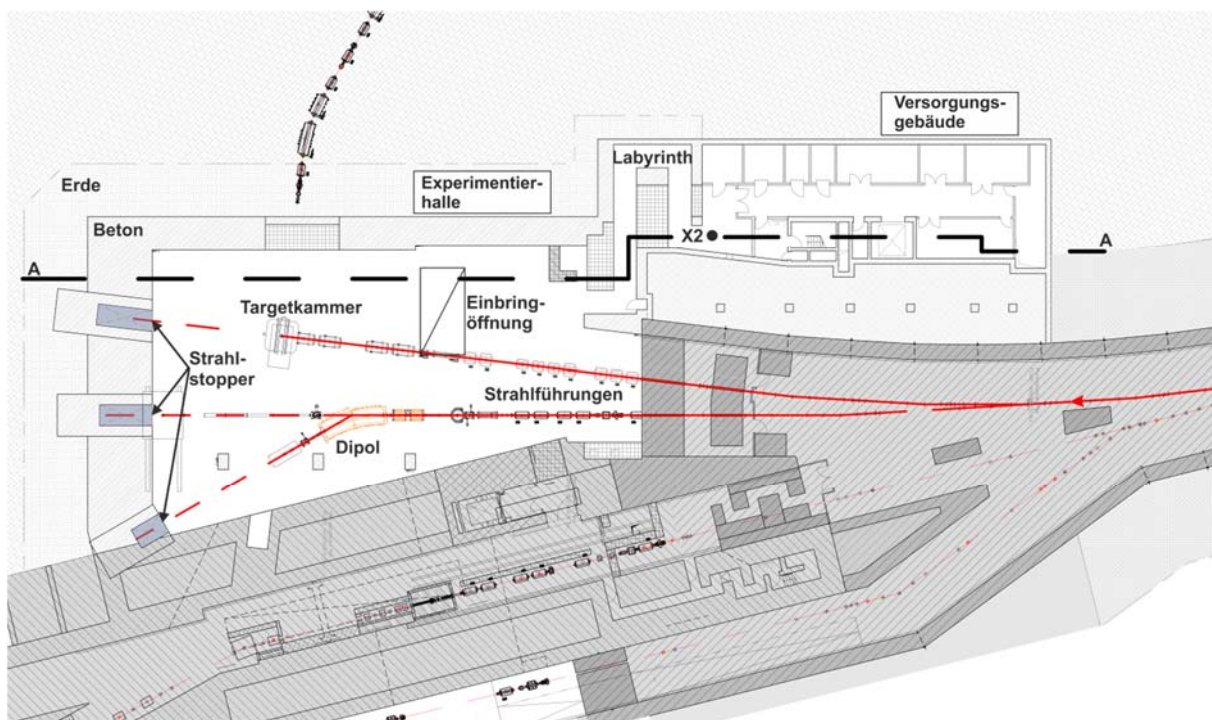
Grundriss der strahlführenden Ebene. Dargestellt ist die Experimentierhalle, mit den beiden Strahlführungen und den drei Strahlstoppnern hinter den Experimentierplätzen der jeweiligen Kollaborationen. In diesem Bericht werden die Einbringöffnung und das Strahlenschutzlabyrinth im Hinblick auf den baulichen Strahlenschutz betrachtet. Die Einbringöffnung dient zur Einbringung großer Komponenten durch die Hallendecke in die Experimentierhalle. Das Strahlenschutzlabyrinth schirmt die Direktstrahlung aus der Experimentierhalle in das Versorgungsgebäude ab.
